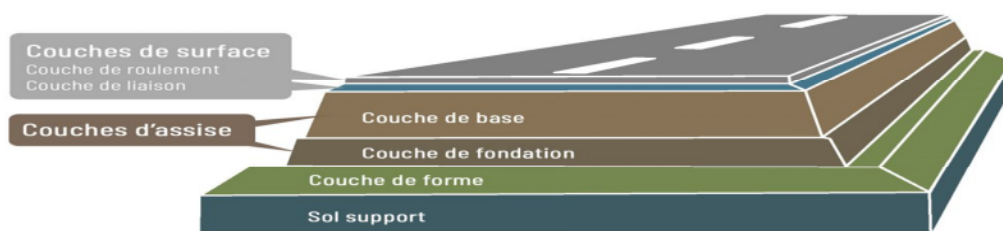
coupe transversale d'une chaussée (Emmanuel Mengue (2015)).
